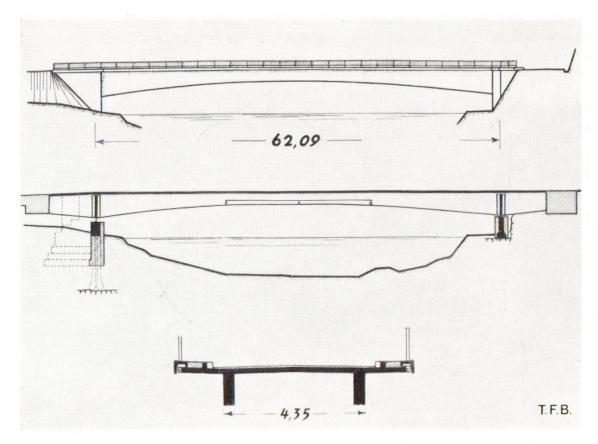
Plan du pont sur la Lahn à Balduinstein, poutre simple avec contrepoids
